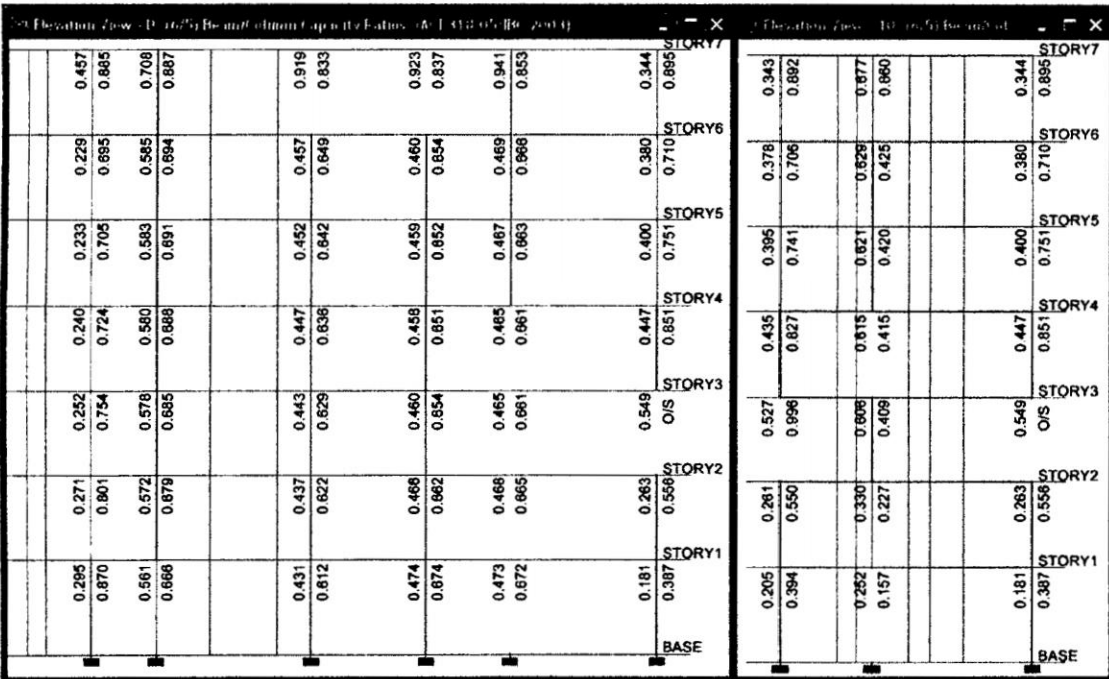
Revisión de columna fuerte viga débil con Etabs en el eje D-D y 10-10
